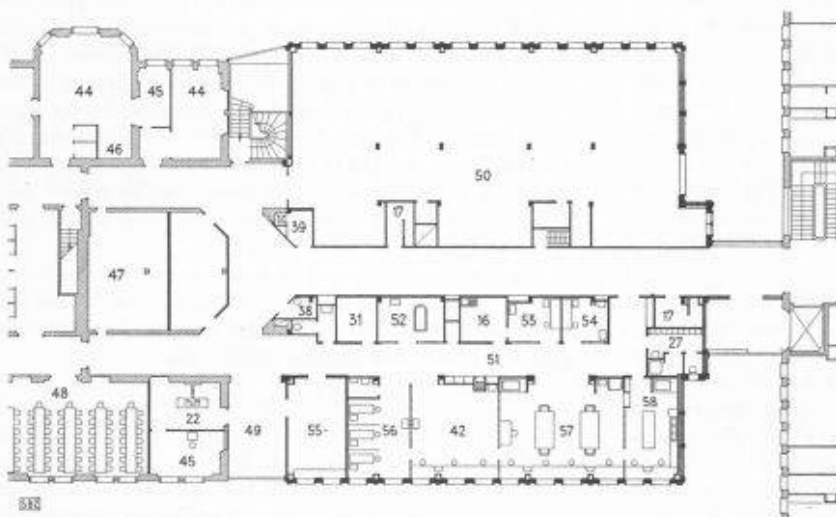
Plan du rez-de-chaussée inférieur, laboratoires — Ech. 1 : 450.
